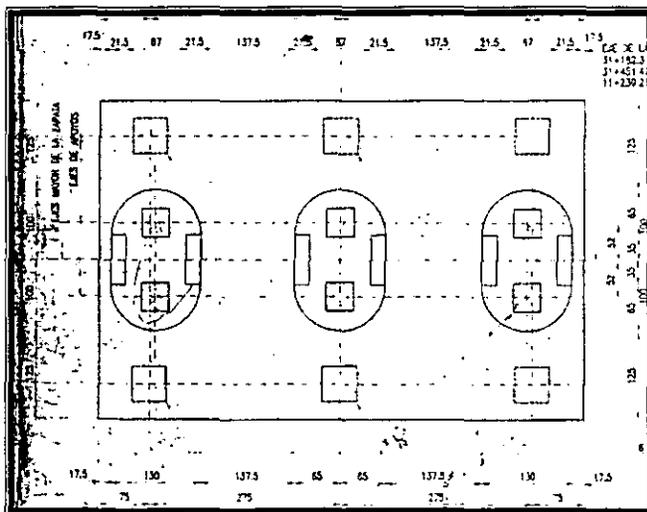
a. Geometría de la pila de sección oblonga. En planta.
